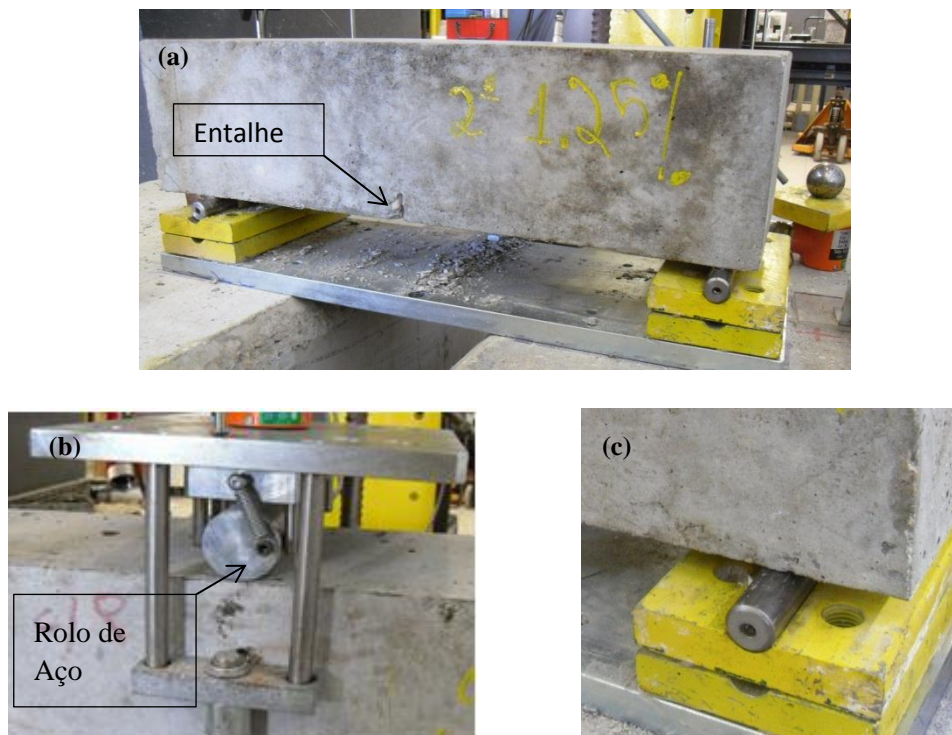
Sistema de ensaio da viga, (a) viga pousada sobre os rolos de aço, (b) sistema de carga sobre a viga e (c) pormenor de um dos apoios.
